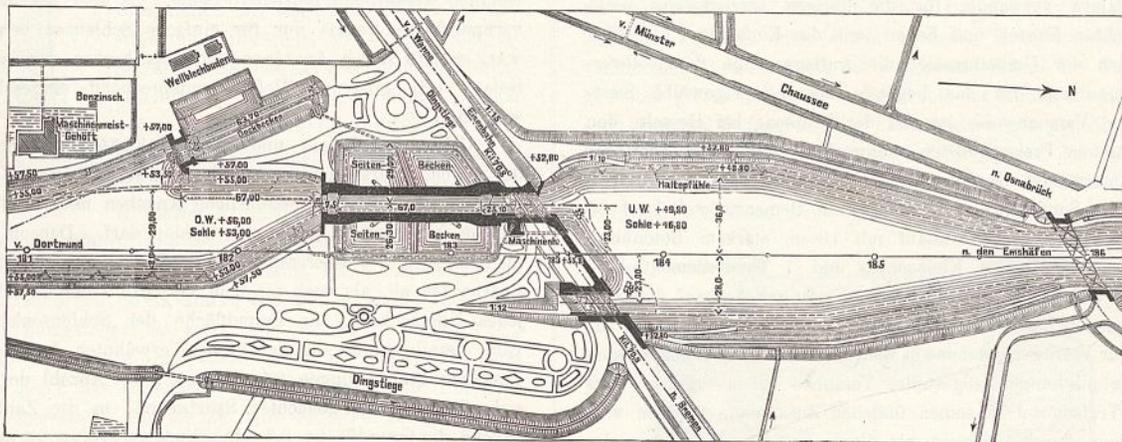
Lageplan der Schleuse bei Münster. 1 : 3000.
